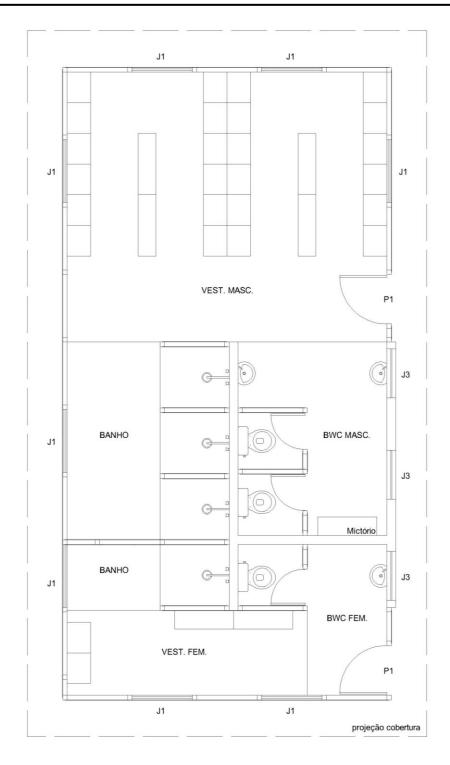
Layout* de referência de sanitário e vestiário em canteiro de obra, em chapa de madeira compensada, utilizado para fins de especificação.
